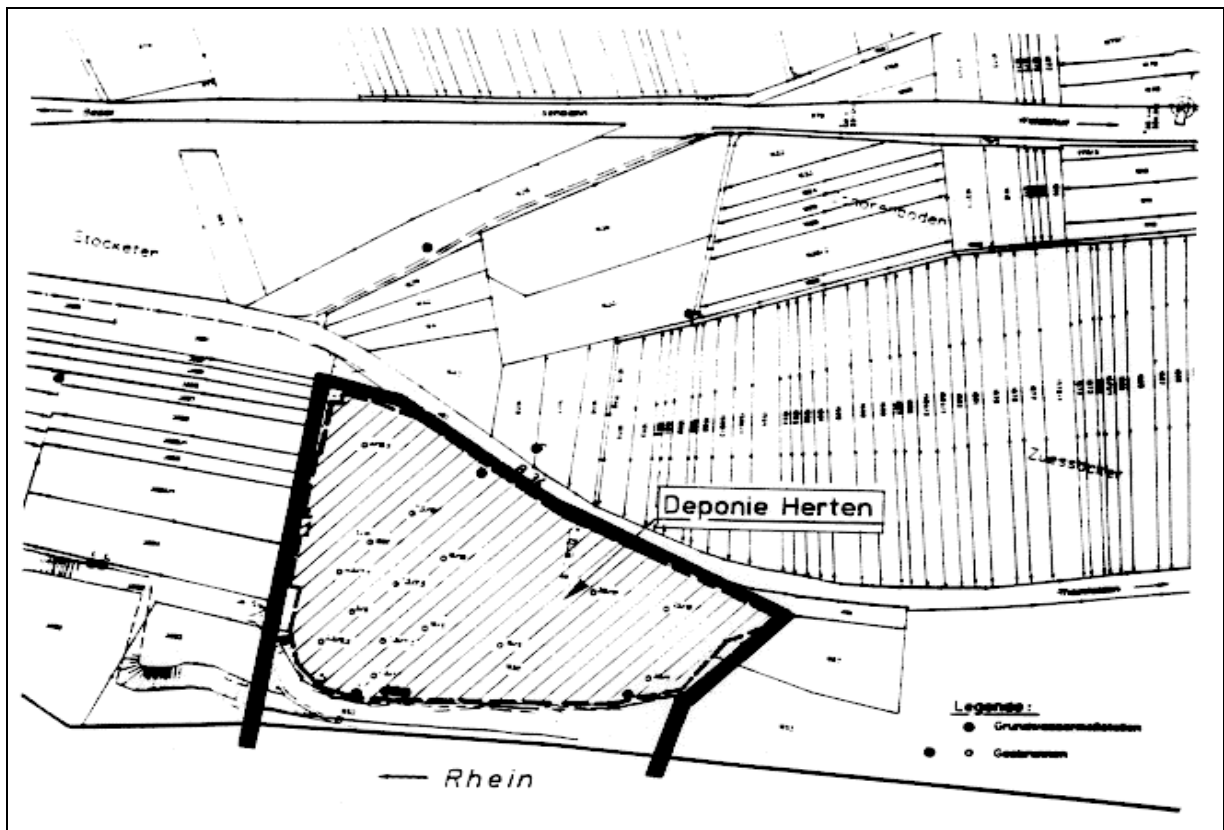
Prinzipgrundriß Sanierungsvorschlag 1 (Verfahren VI)
